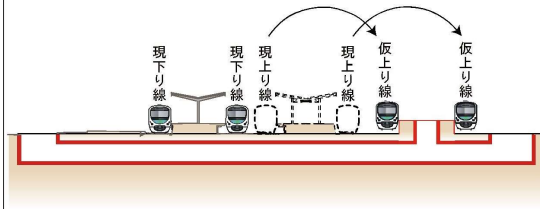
(3) 施工順序図（武蔵関駅）
